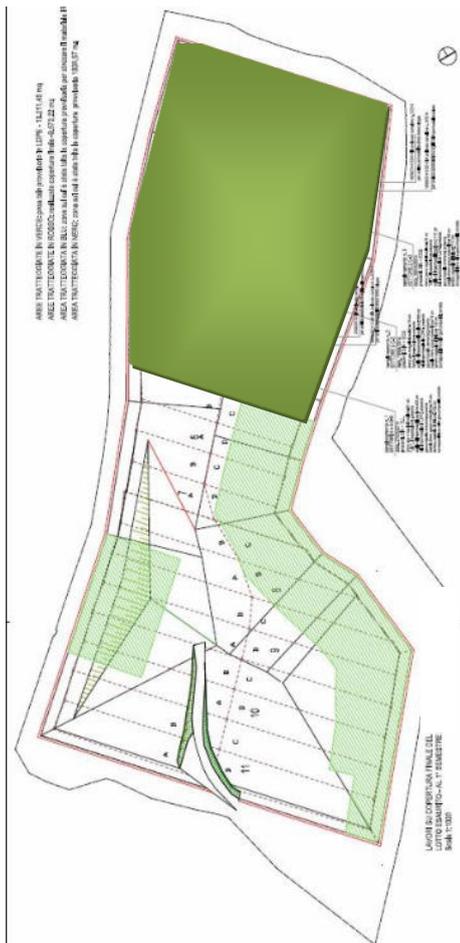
Planimetria stato avanzamento lavori di copertura finale
